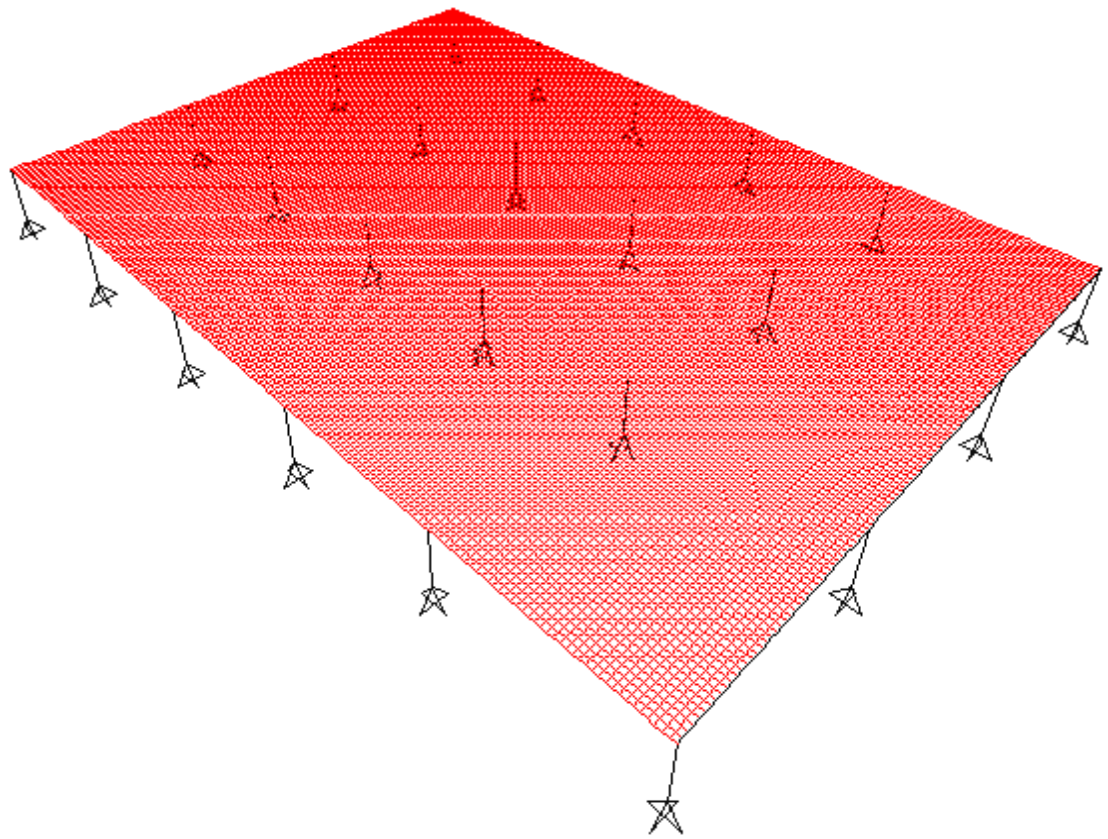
Laje Lisa sobre apoios lineares – Vista 3D
